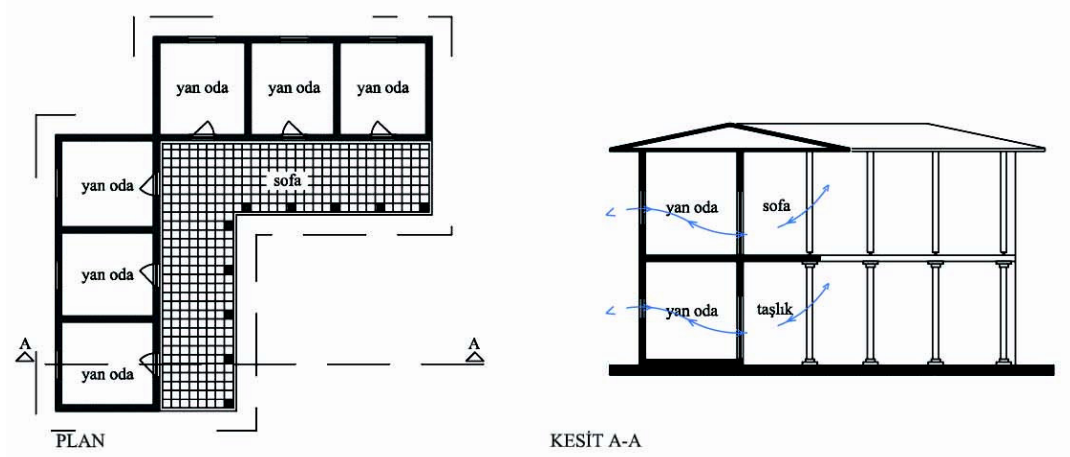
Yan (I) sofalı tip plan ve kesitleri
